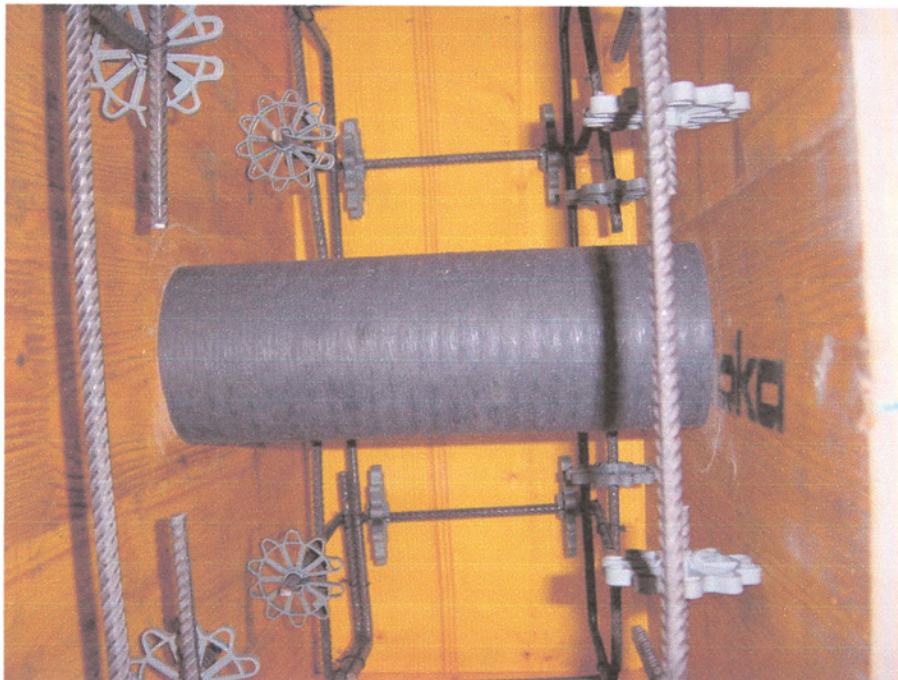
Eingebaute Mauerhülse vor dem Betonieren
